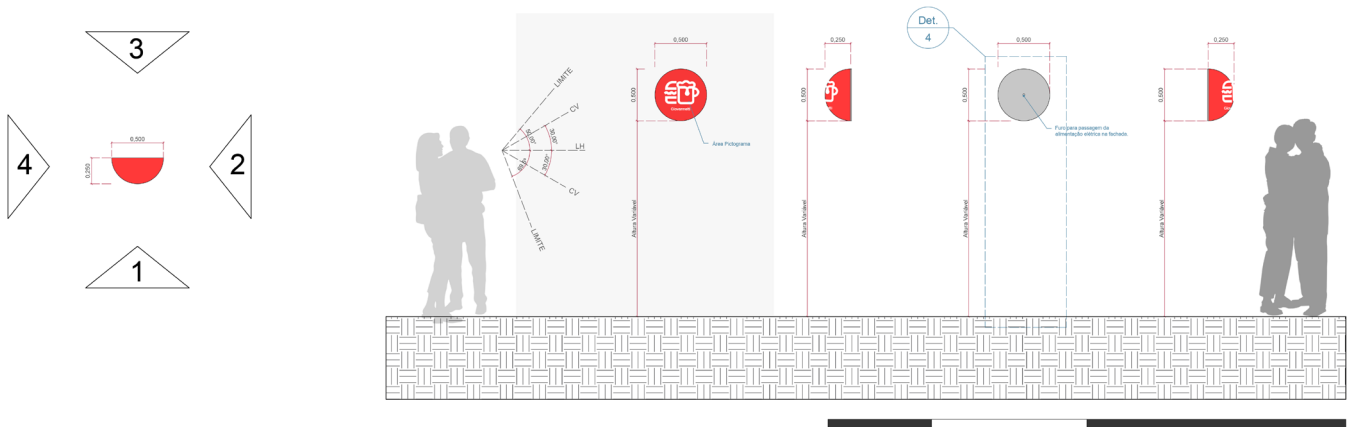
Vistas PIN fachadas / Fonte: Autoria do grupo.
